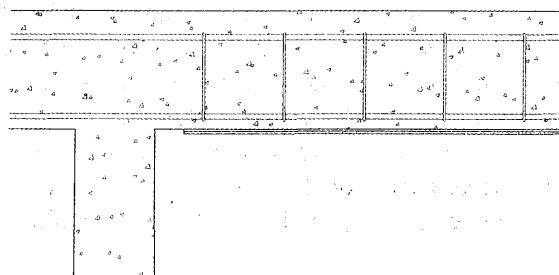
19. Refuerzo de vigas con chapa de acero adherida.
